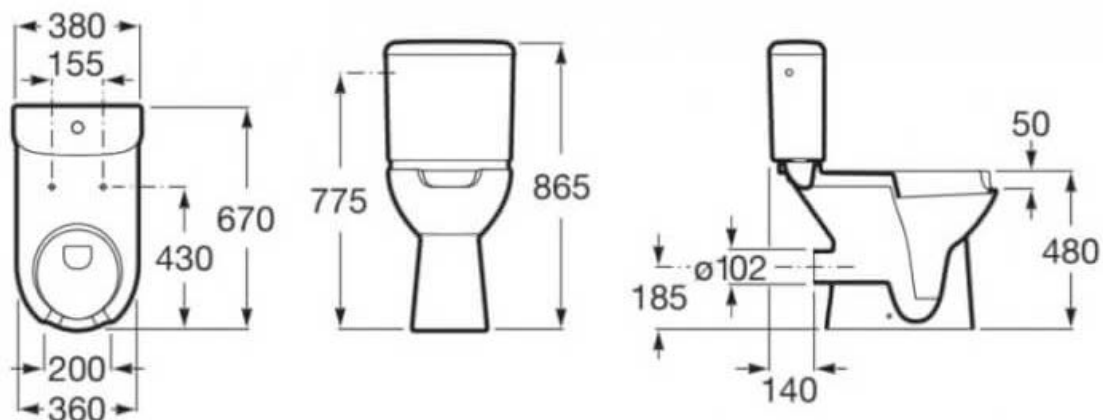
Planos del inodoro completo 81 Access de ROCA o similar.
